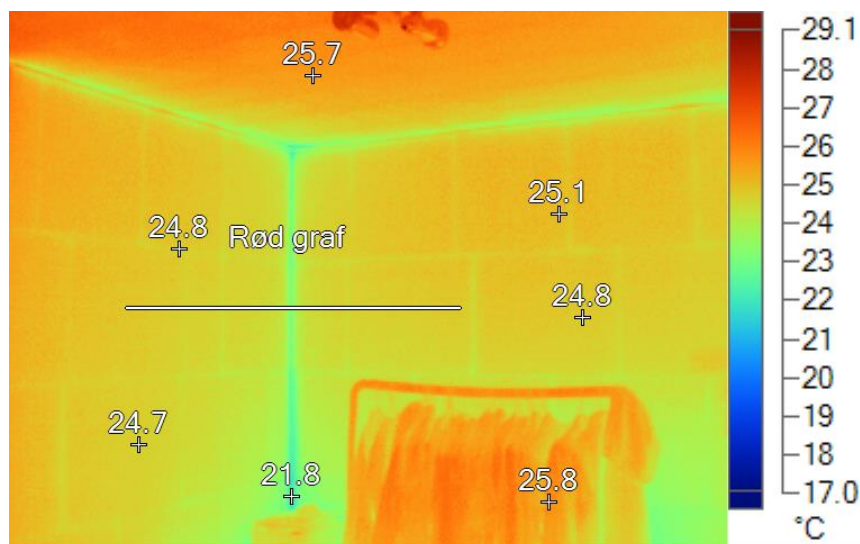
Begge vægge er indvendigt efterisoleret.
